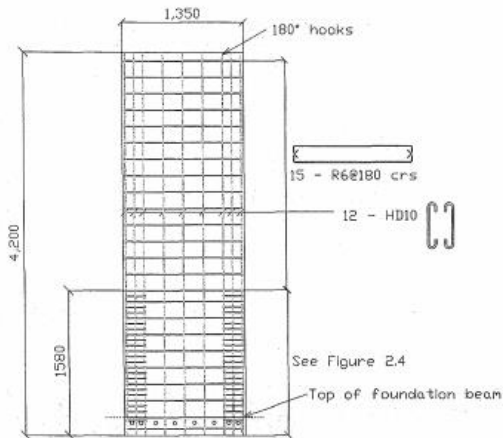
5 Potongan Benda Uji Riset PRESSS
